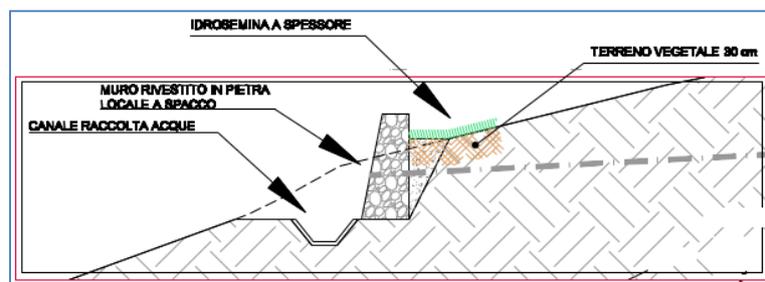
Inerbimento area lavorazione "dreni sub-orizzontali" - sezione
